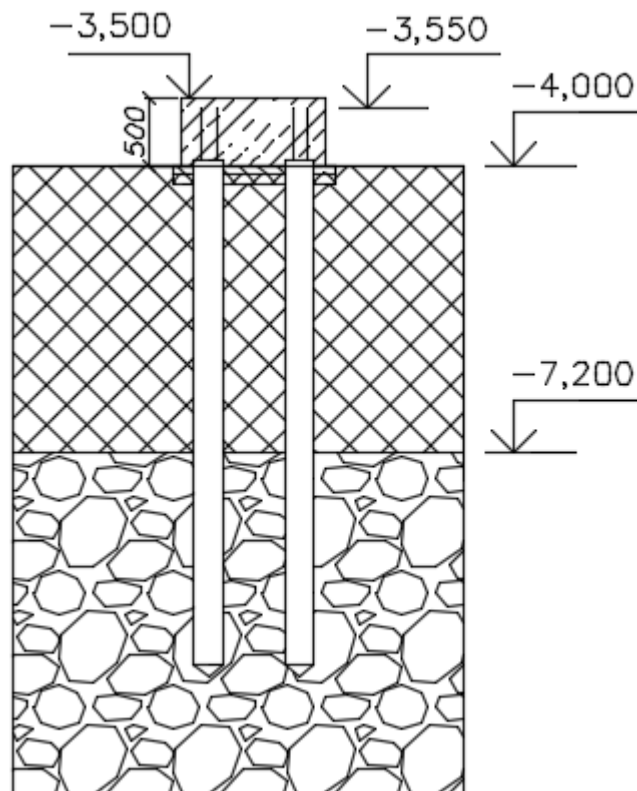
Инженерно-геологический разрез и отметки фундамента
